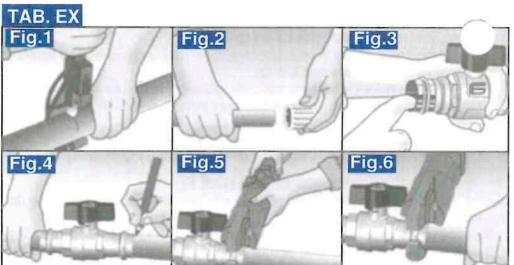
Tagliare il tubo, ad angolo retto • Cut the pipe at right angle. • Couper le tube à angle droit. • Abschneiden das Rohr um rechte Ecke • Cortar el tubo en ángulo recto.
